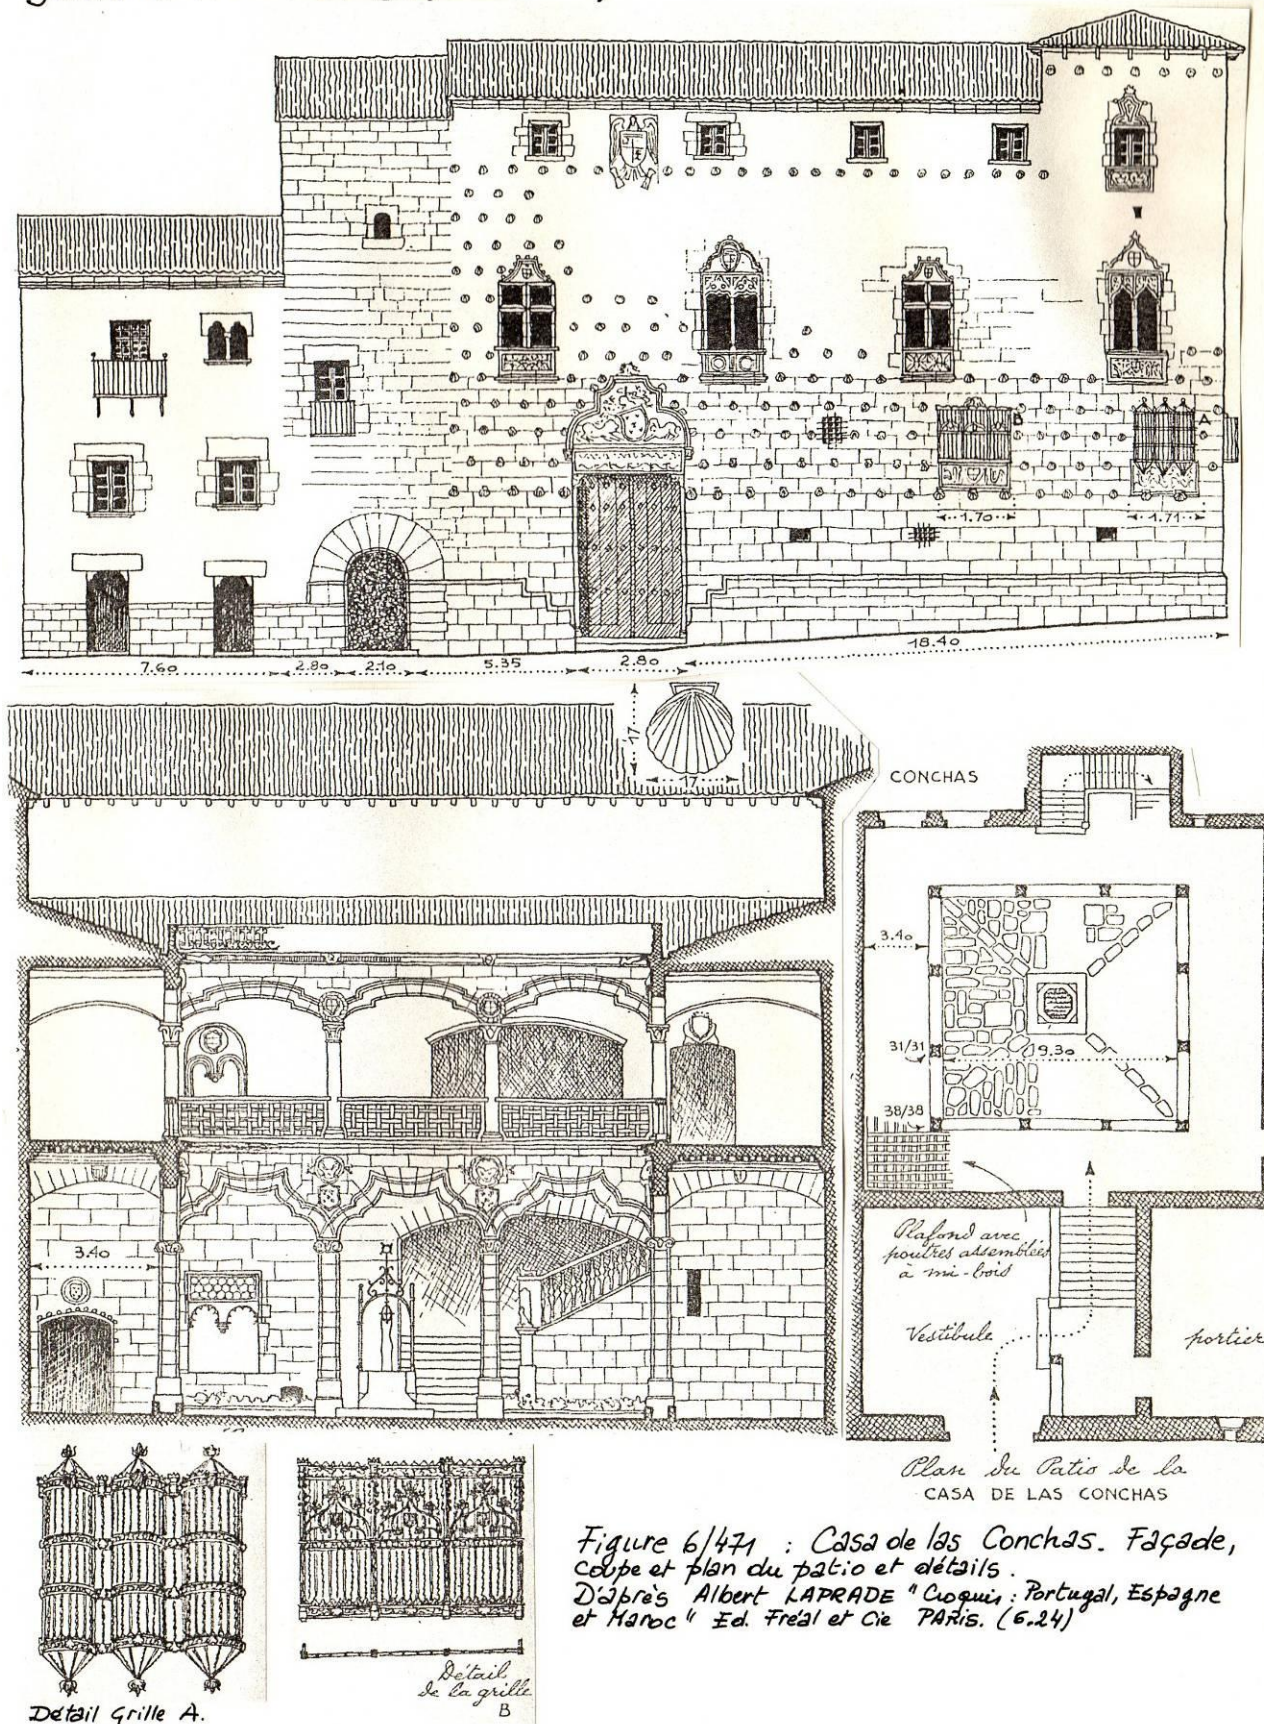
/471 : Casa de las Conchas. Façade, coupe et plan du patio et détails.
